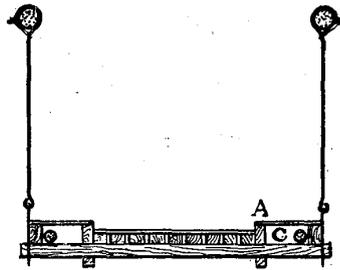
Coupe transversale du tablier du pont montrant la position des contre-câbles ou câbles de contreventement.
